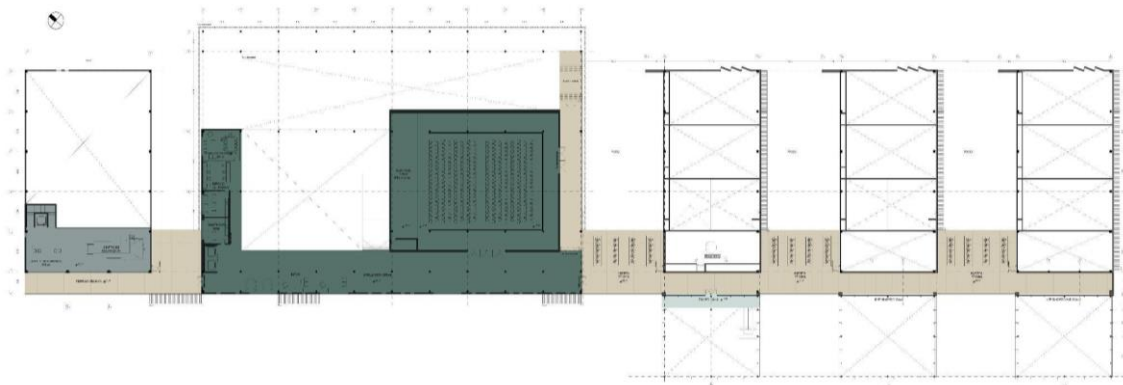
Planta de entresijos del proyecto “Instituto Técnico Despeñaderos”.
